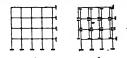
Многоэтажная многопролетная рама: α — заданняя схема; δ — расчлененная схема.
